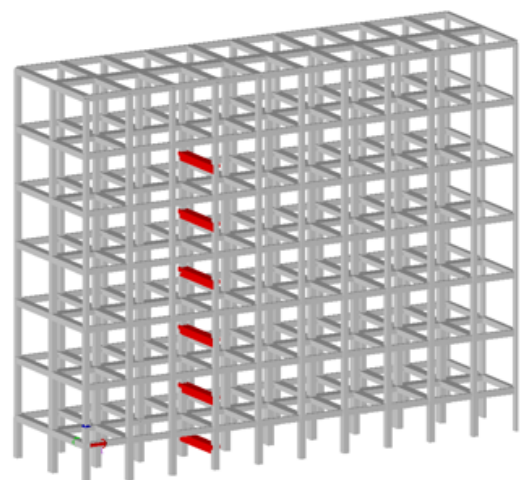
Modello US B1 - PROSAP, Archivio Sezioni, Proprietà n° 12 Trave Princ. Vano Scale, con inquadramento.
